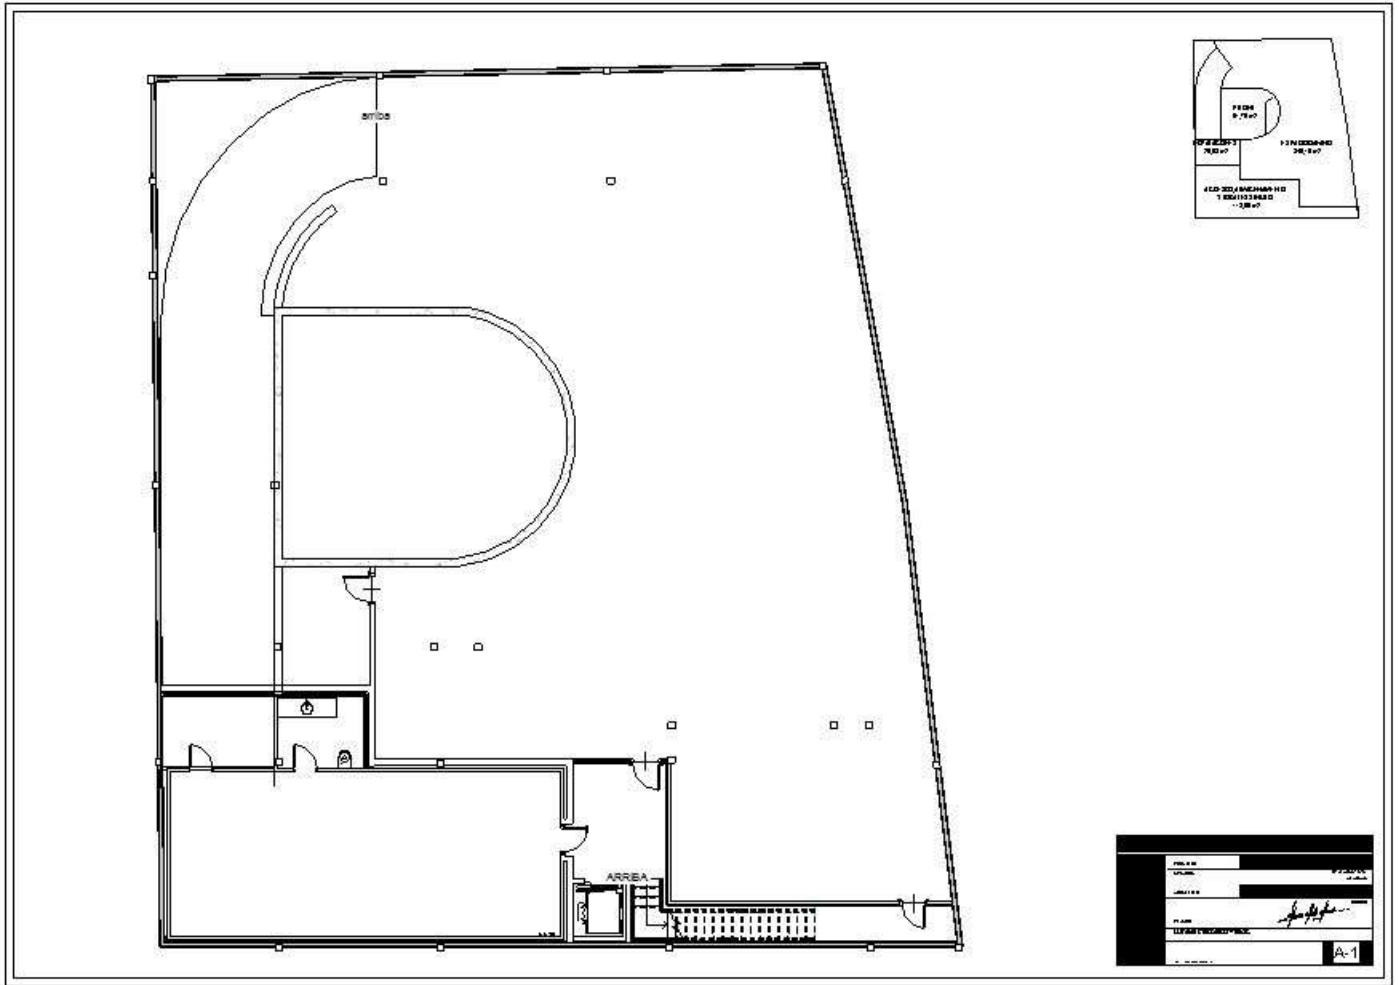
Plano Arquitectónico A-1. Planta Sótano. Fuente propia. 2016
